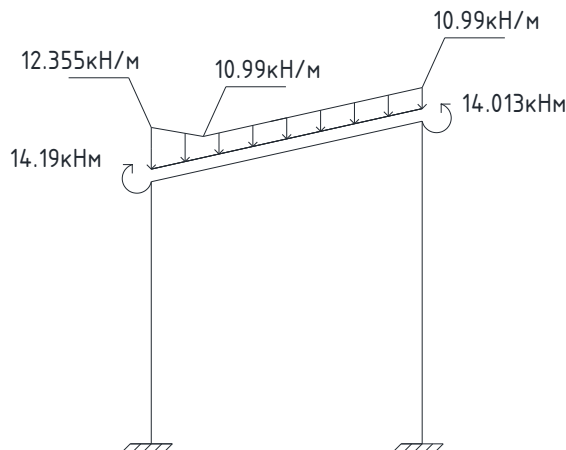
Схема прикладання снігового навантаження до поперечної рами
